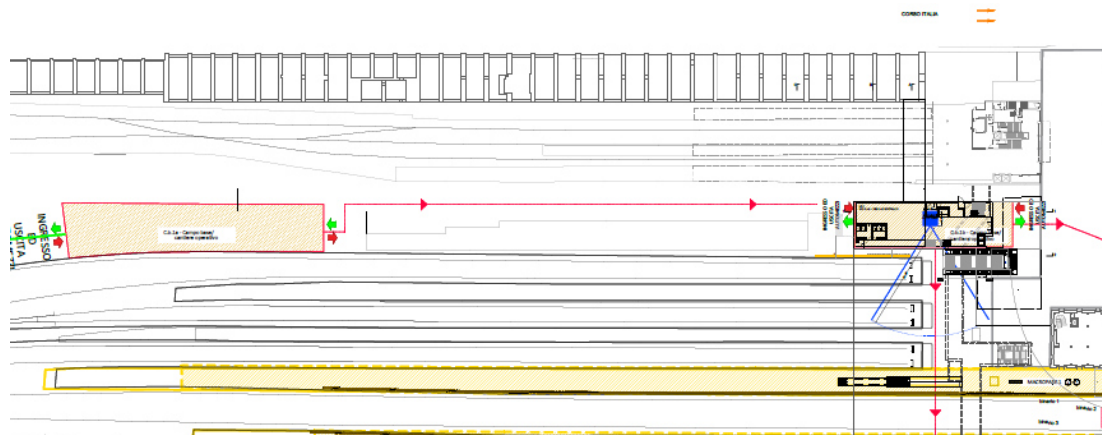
Localizzazione cantieri Cb.1a e AT.1b
